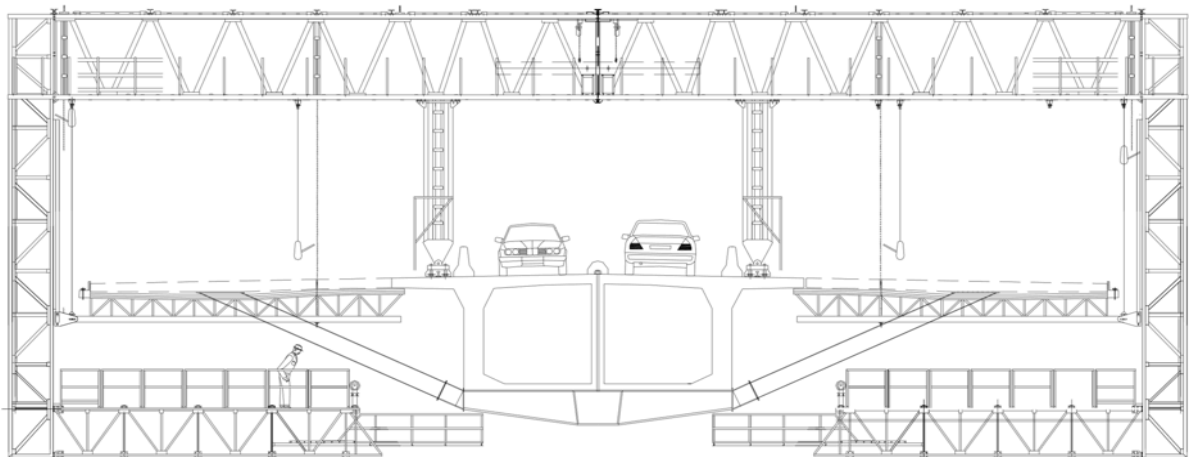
FASE 2- Encofrado móvil dispuesto sobre el tablero, estructura metálica colocada en su posición, le continuara una FASE 3- Hormigonado de la losa.
